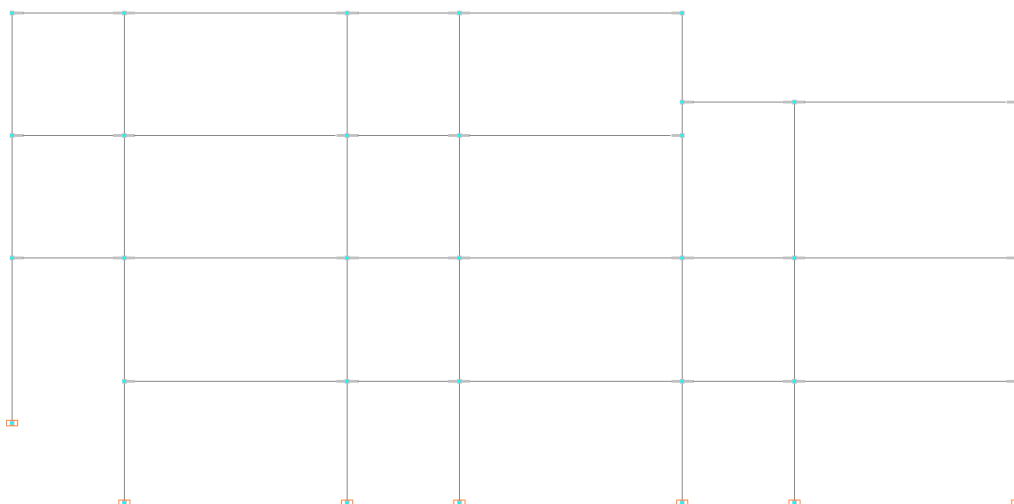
Расчетная схема поперечной рамы в осях 7...А/1-Ж
